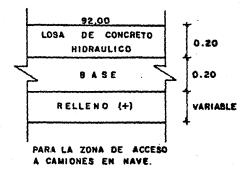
SECCIONES DE PAVIMENTOS
